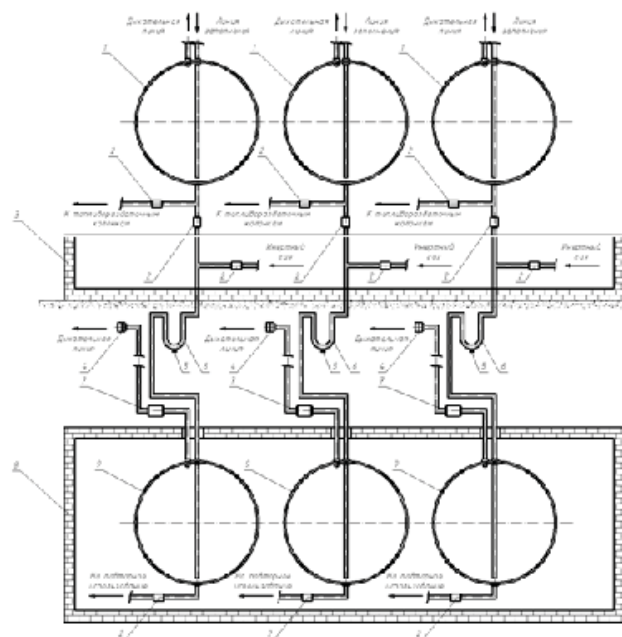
Схема усовершенствованной системы аварийного слива топлива (вертикальный разрез): 1 – топливный резервуар; 2 – задвижка автоматическая с пробковым краном; 3 – стенка обвалования; 4 – сетчатый огнепреградитель; 5 – пробка; 6 – гидравлический затвор; 7 – сетчатый огнепреградитель; 8 – подземное помещение; 9 – аварийная емкость
